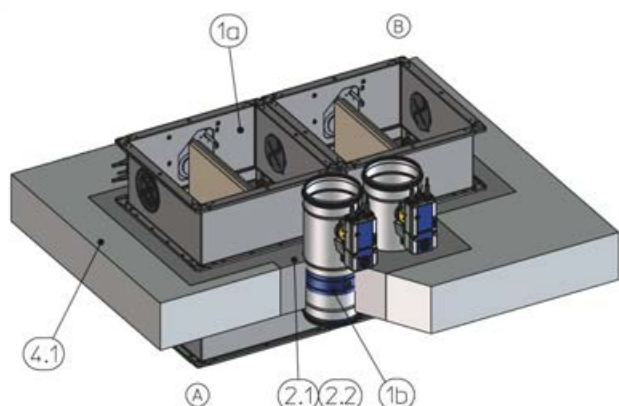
Installazione in muratura in un soffitto a soletta piena, flangia a flangia, l'illustrazione mostra l'installazione verticale (vale anche per l'installazione sospesa)
